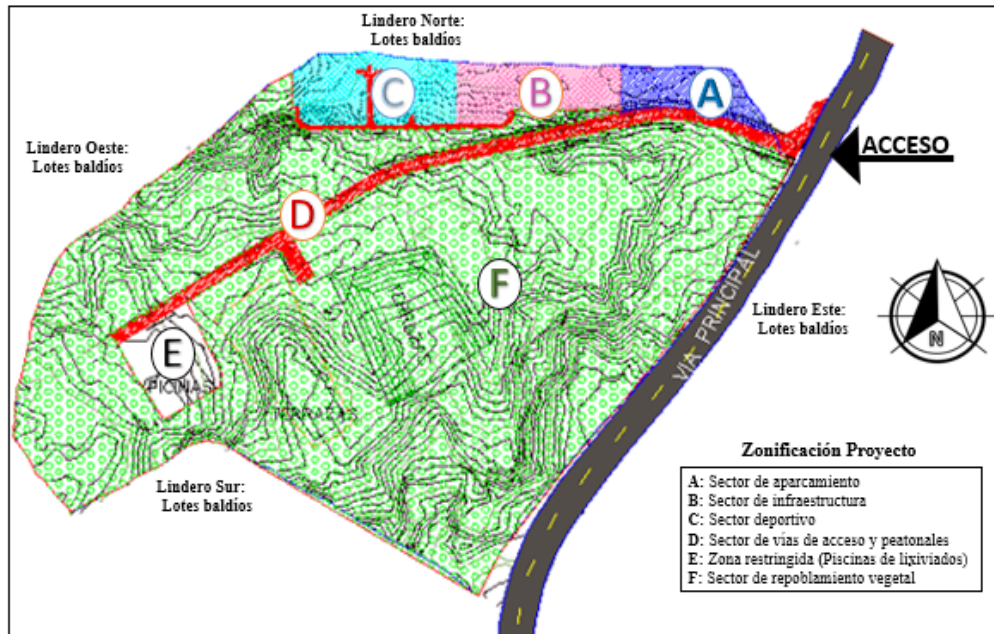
Zonificación del terreno a intervenir en el presente proyecto (Anexo Plano N°4).
